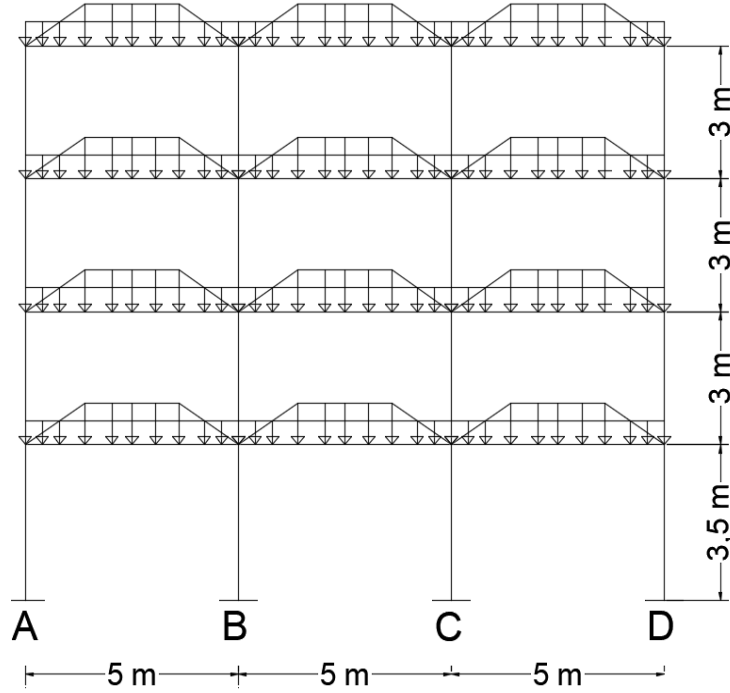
Kat kalıp planı ve şematik kesiti.
